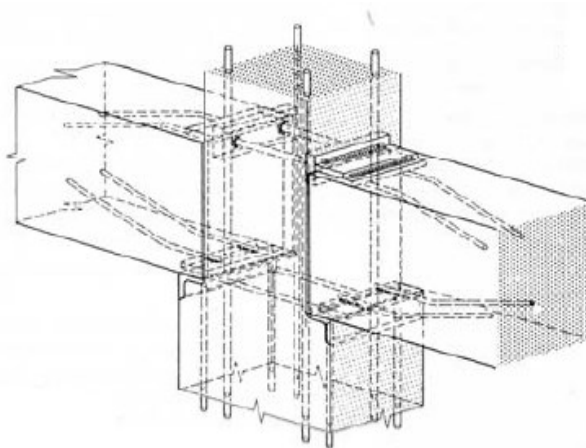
Ligação pilar – viga com continuidade e recurso a chapas soldadas (STUPRÉ, 1981).
